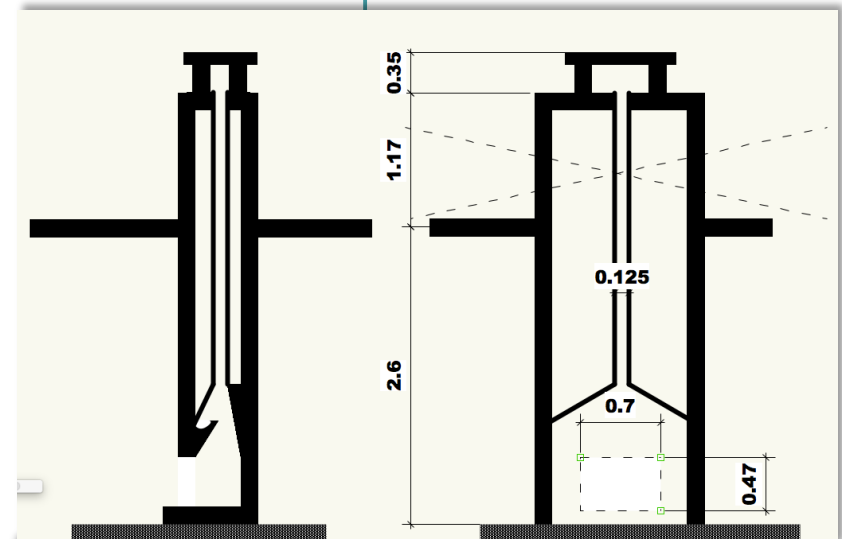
Secciones de chimenea actual. Fuente Propia
